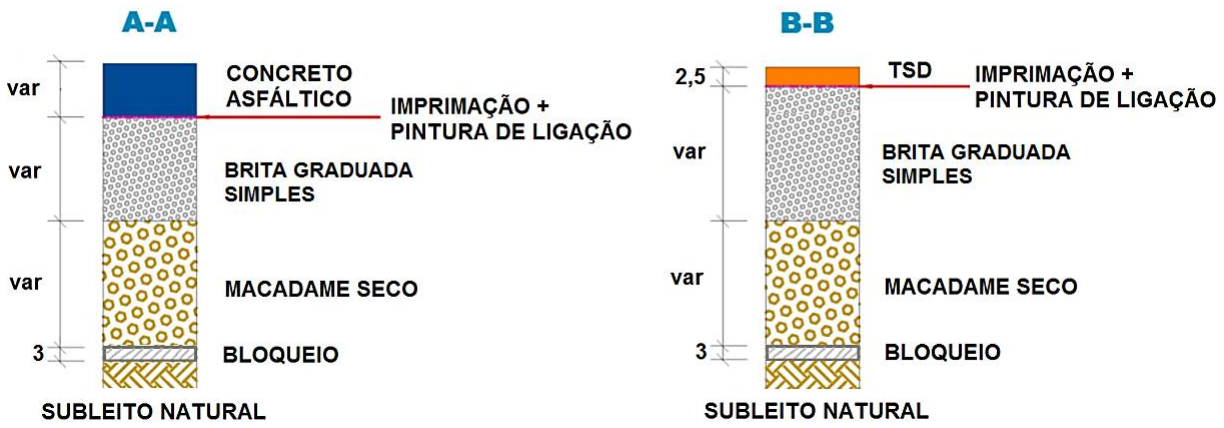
Seções transversais A-A e B-B demonstrando a composição das camadas (pavimentos novos)
